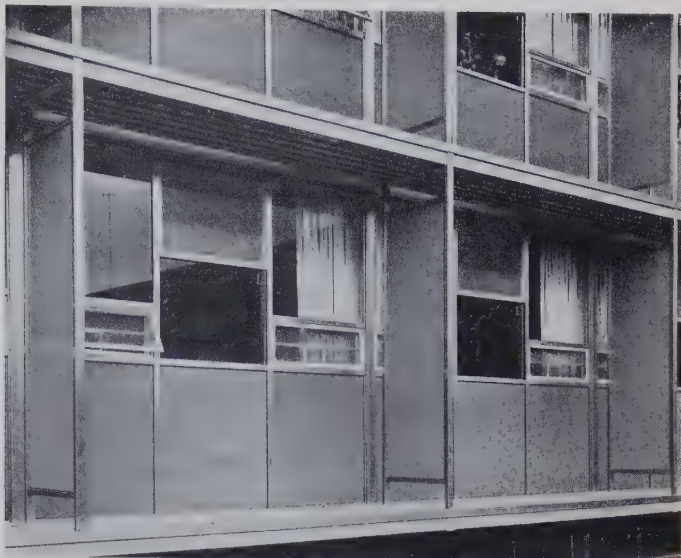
Fassadenausbildung des Pottstown-Spitals
